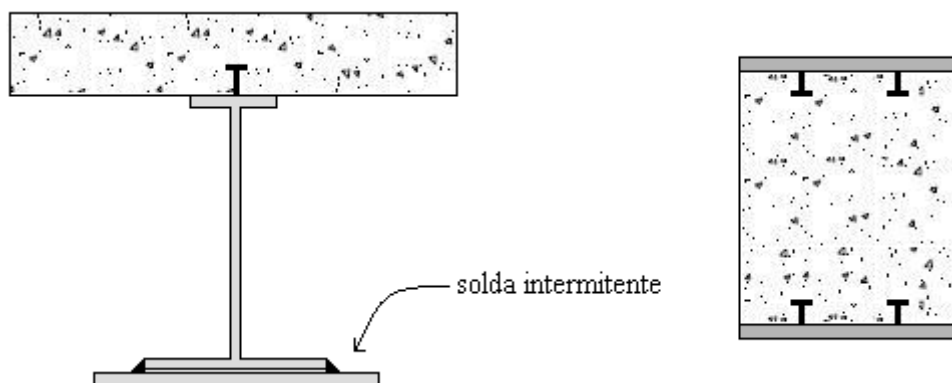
Seções mistas com mais de um plano de deslizamento
